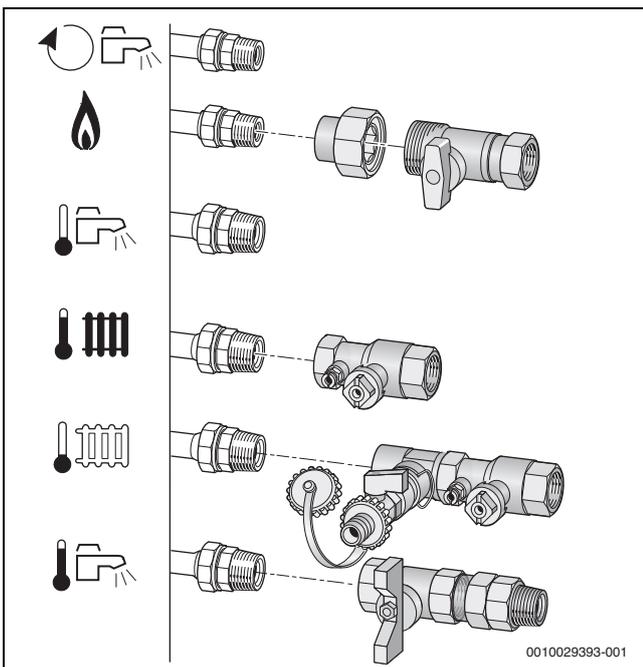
Montage des Armaturen-Sets am Beispiel Anschlüsse nach rechts AS-H1/Horizontales Anschluss-Set
